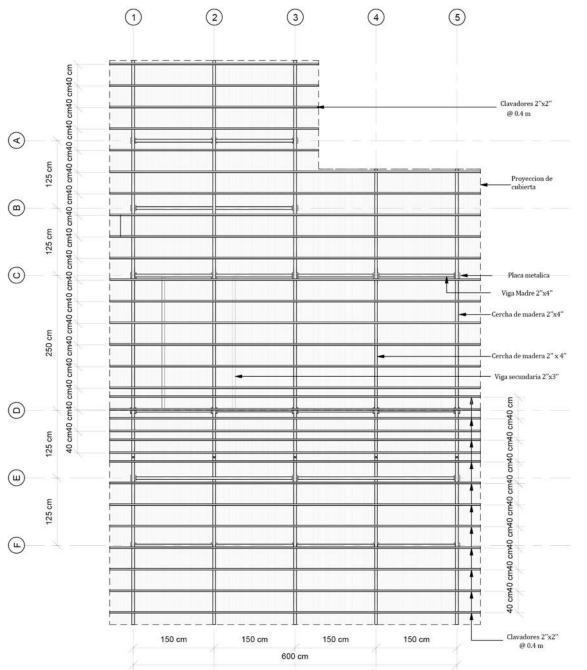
Planta Estructural de Techos Gran Área Metropolitana Fuente: Elaborado por autor
